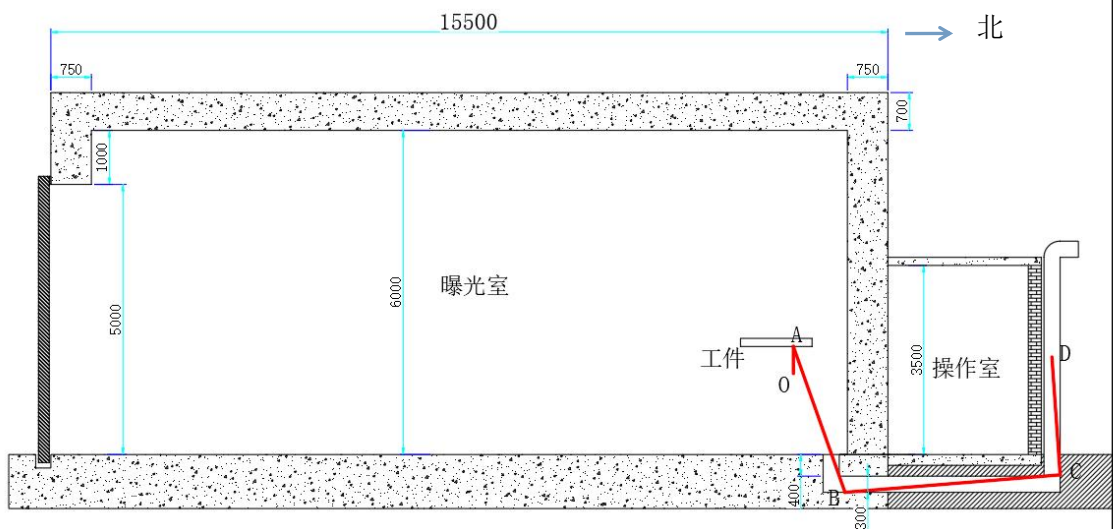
通风管道屏蔽结构示意图（单位：mm）
